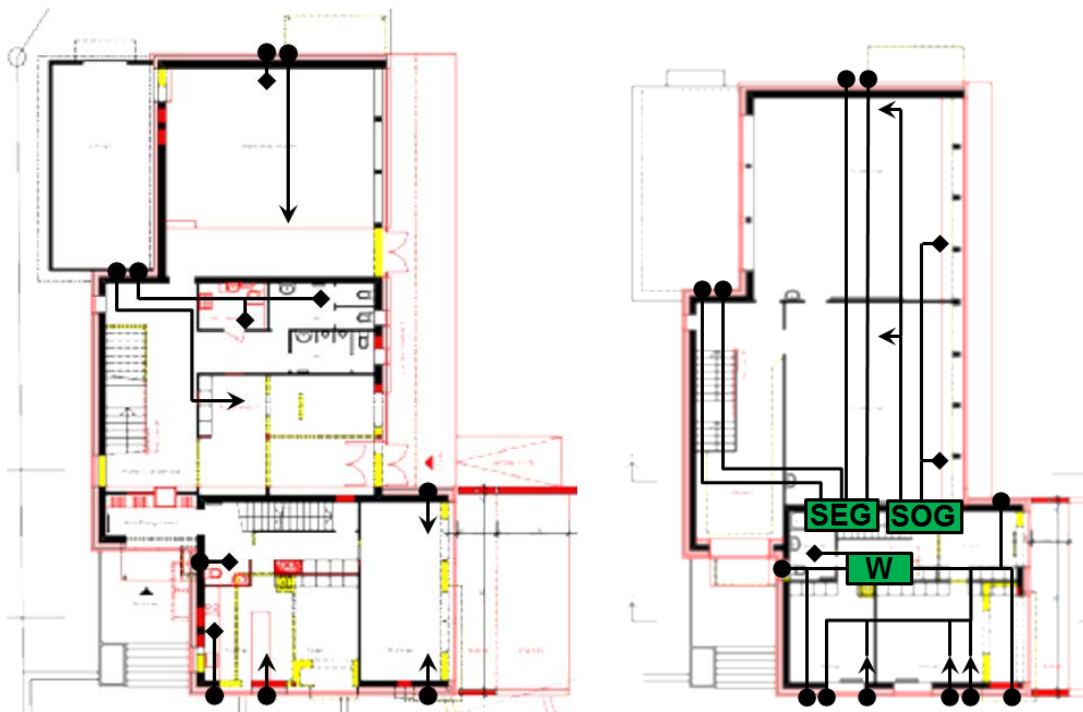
Grundrisse des Schulhauses Krumbach Erdgeschoss (links) und Obergeschoss (rechts)
